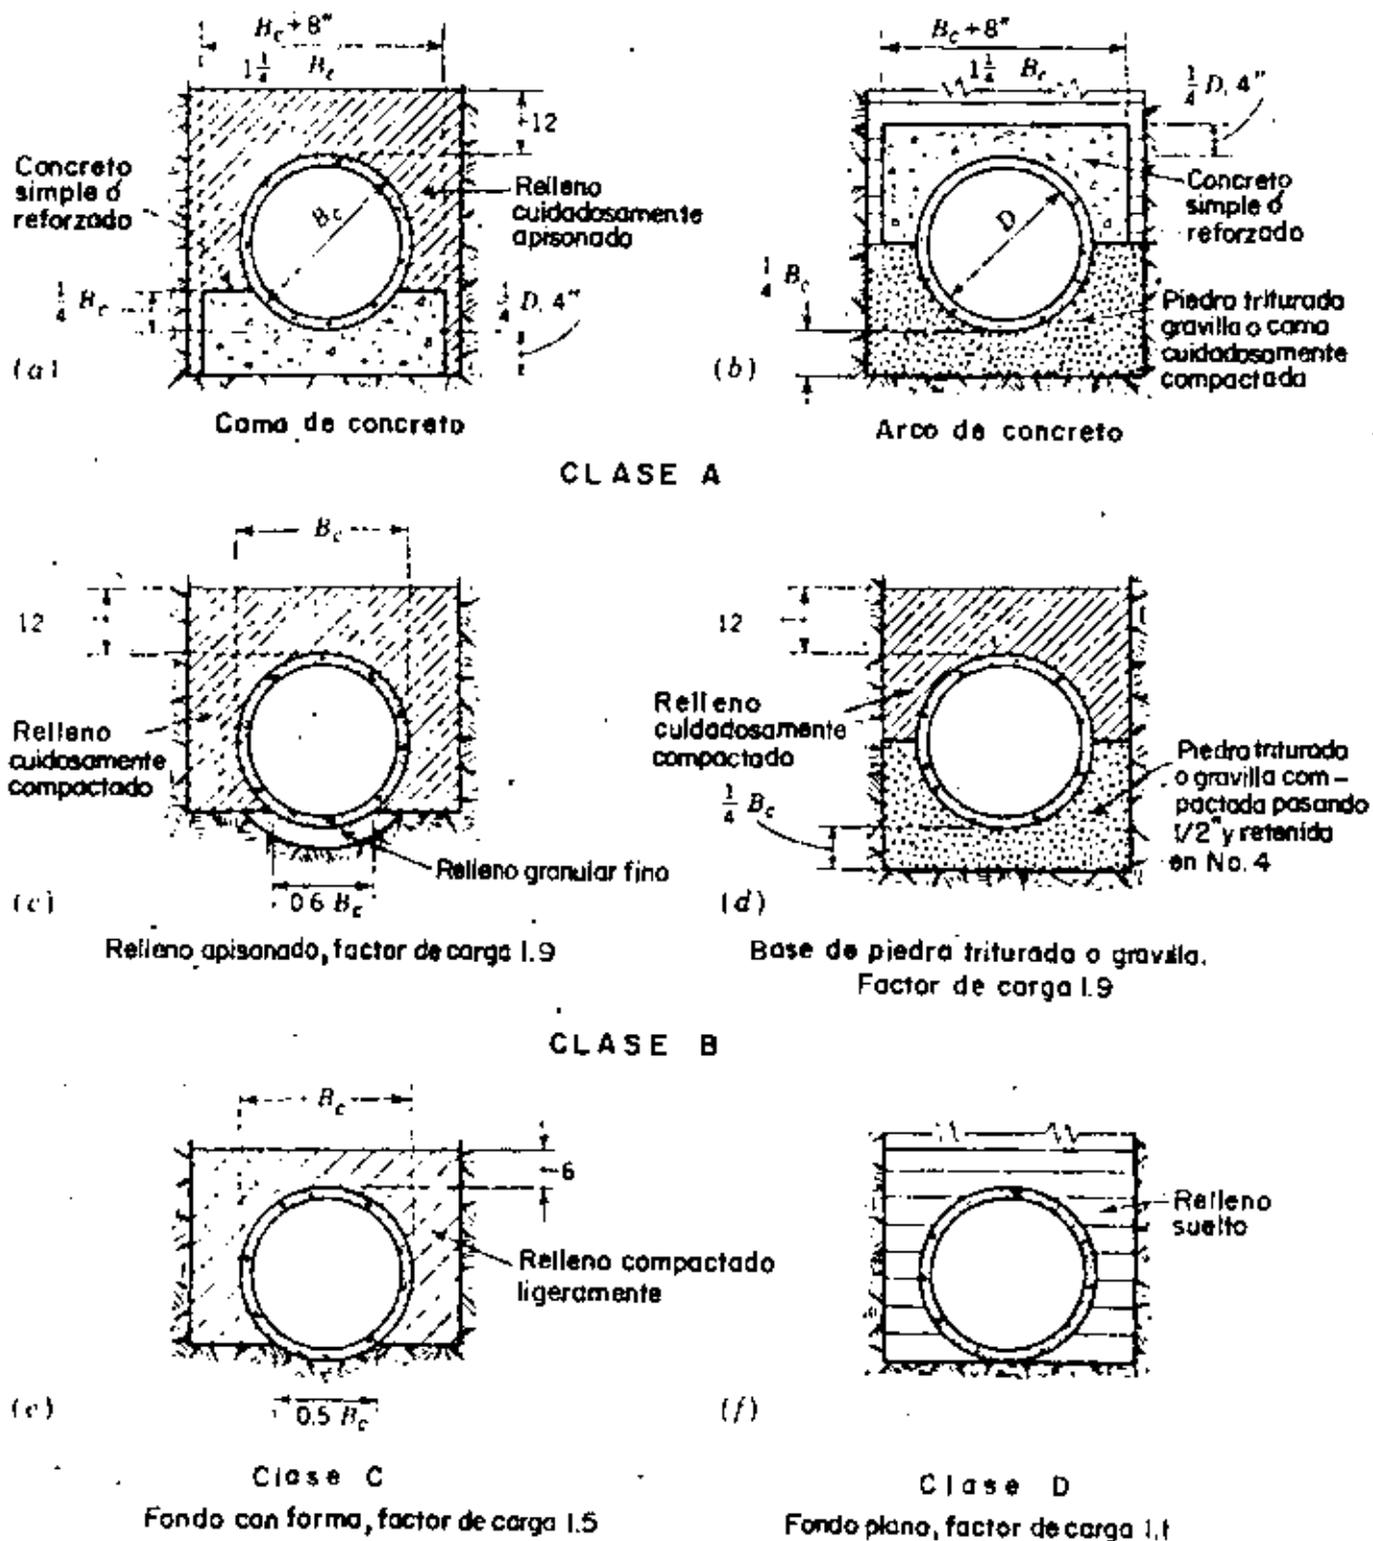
CAMAS DE TUBOS EN ZANJA
